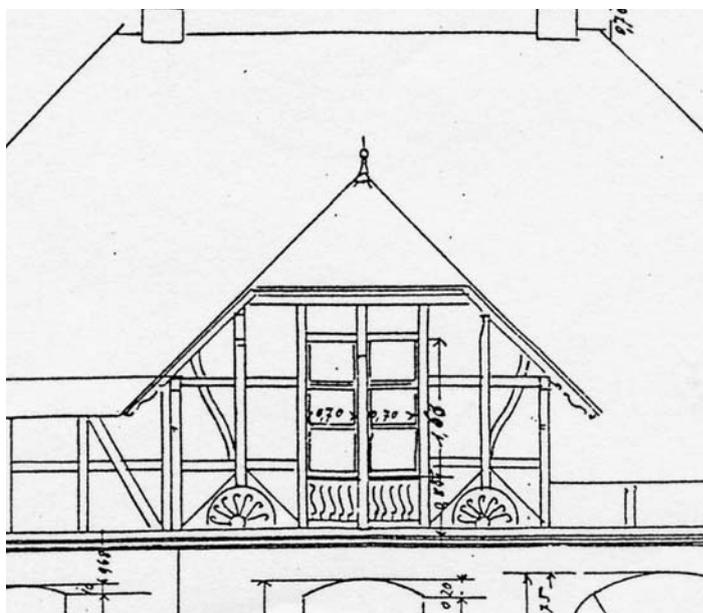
H. Plange, Giebel des eigenen Sommerhauses in Gruiten, Detail der Nordfassade zum Garten, 1898
